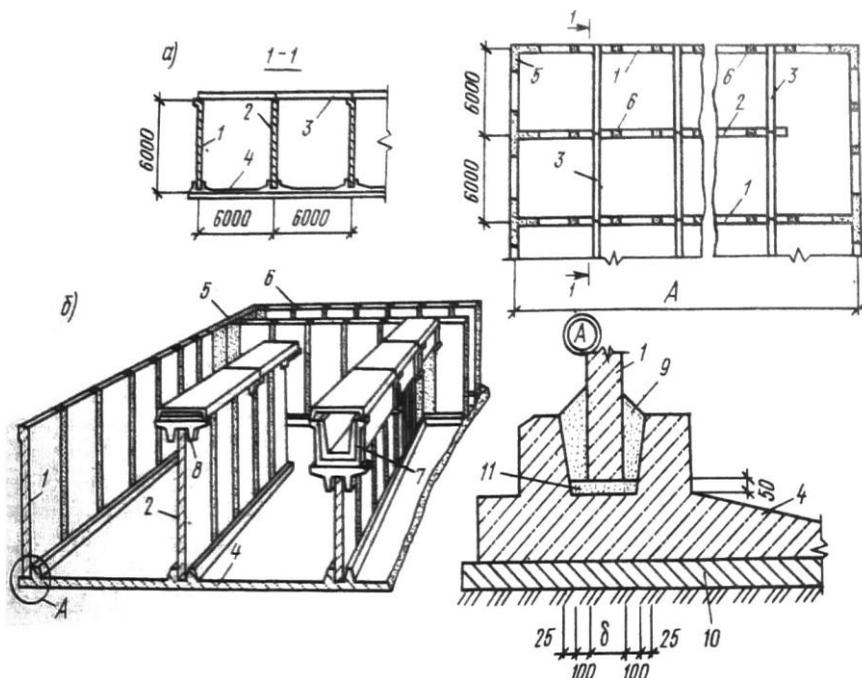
Конструктивное решение азротенка из железобетонных панелей (армирование условно не показано):
